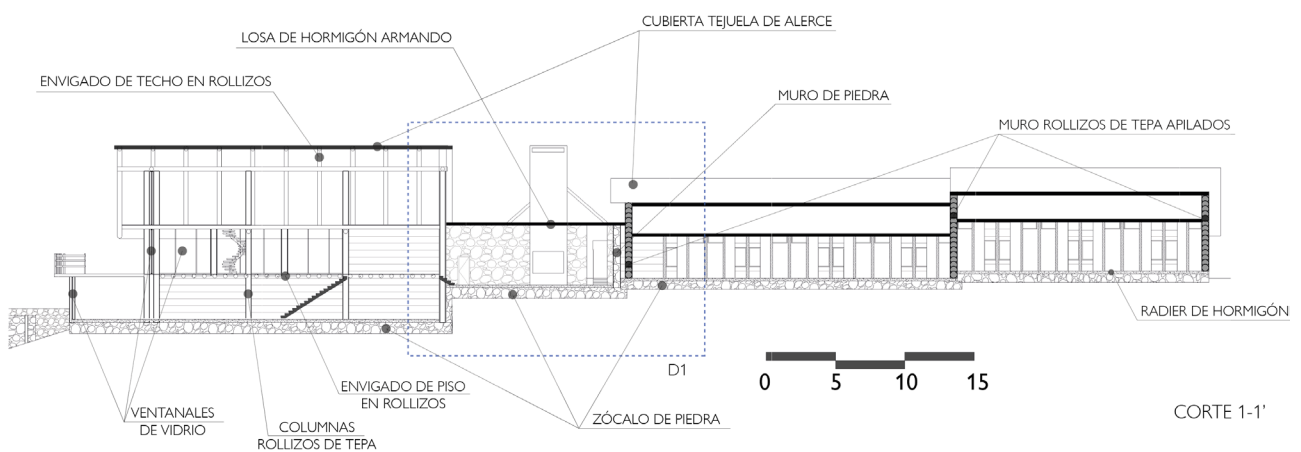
Elementos constructivos generales corte 1-1'. Elaboración propia.
